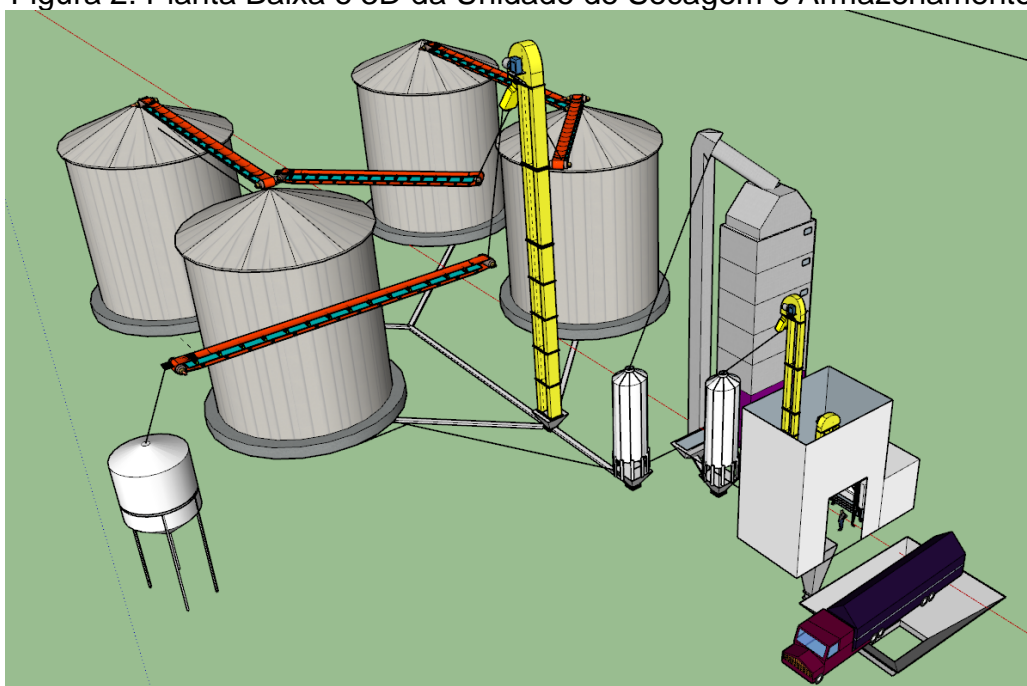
Planta Baixa e 3D da Unidade de Secagem e Armazenamento
